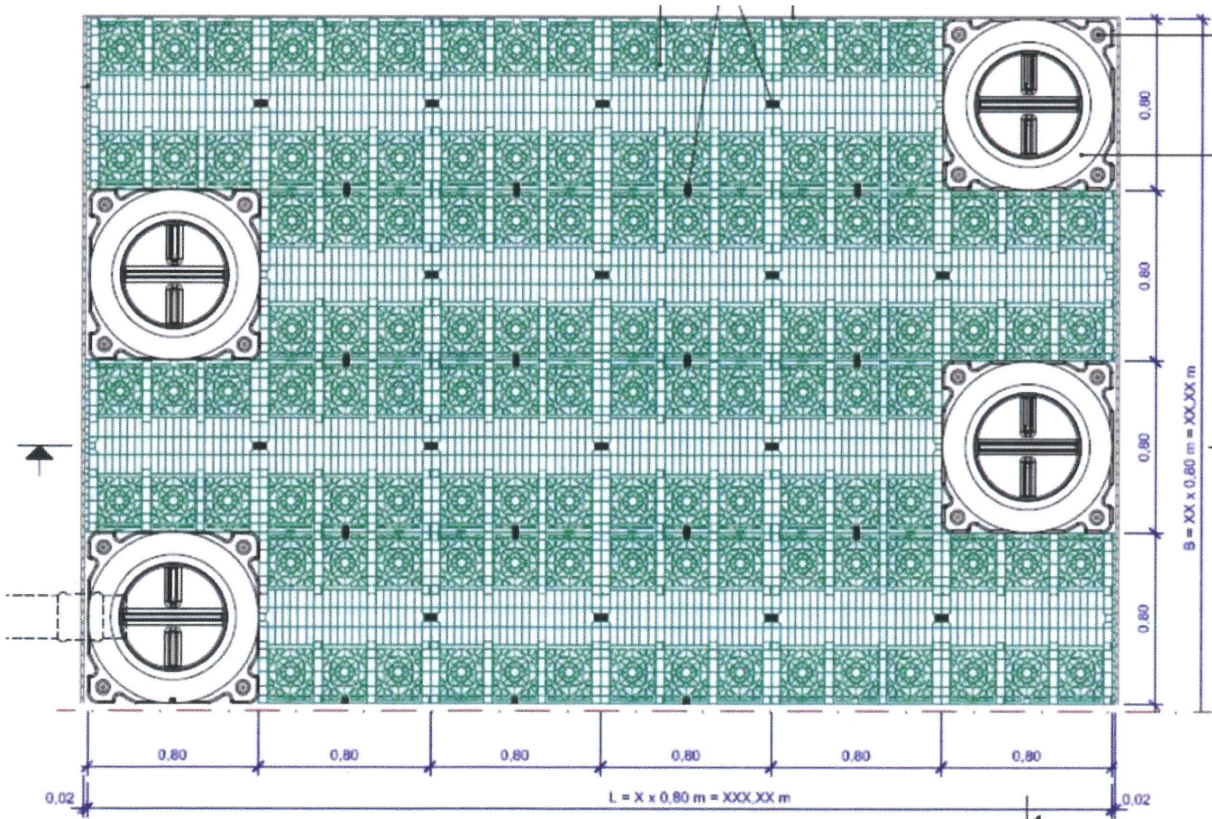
Vue de dessus d'un bassin réalisé avec Rigofill inspect et boîte d'inspection intégrée
